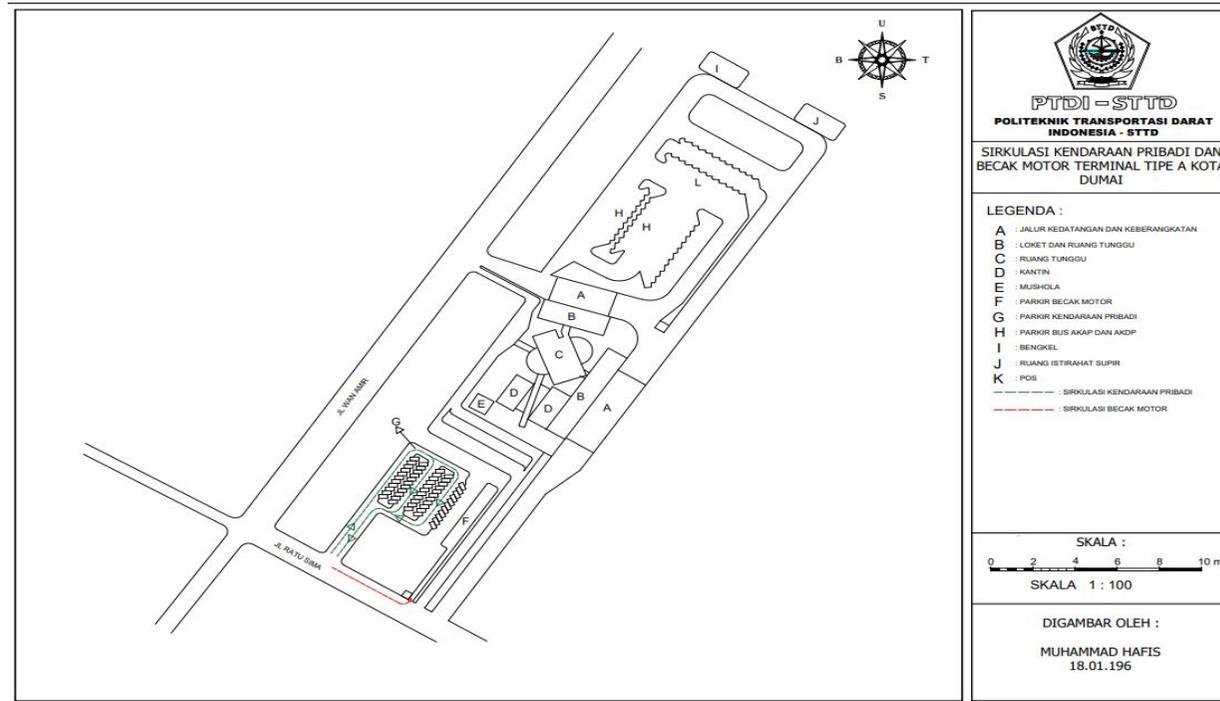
Layout Usulan Terminal Tipe A Dumai
